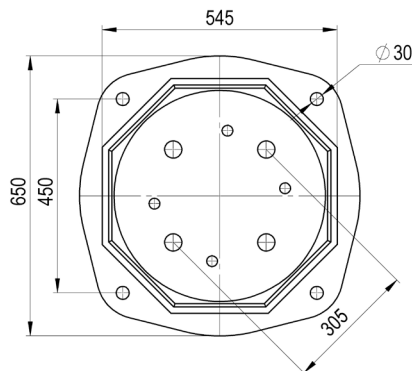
Колодец ККП-2-ССД, вид сверху, габаритные размеры
